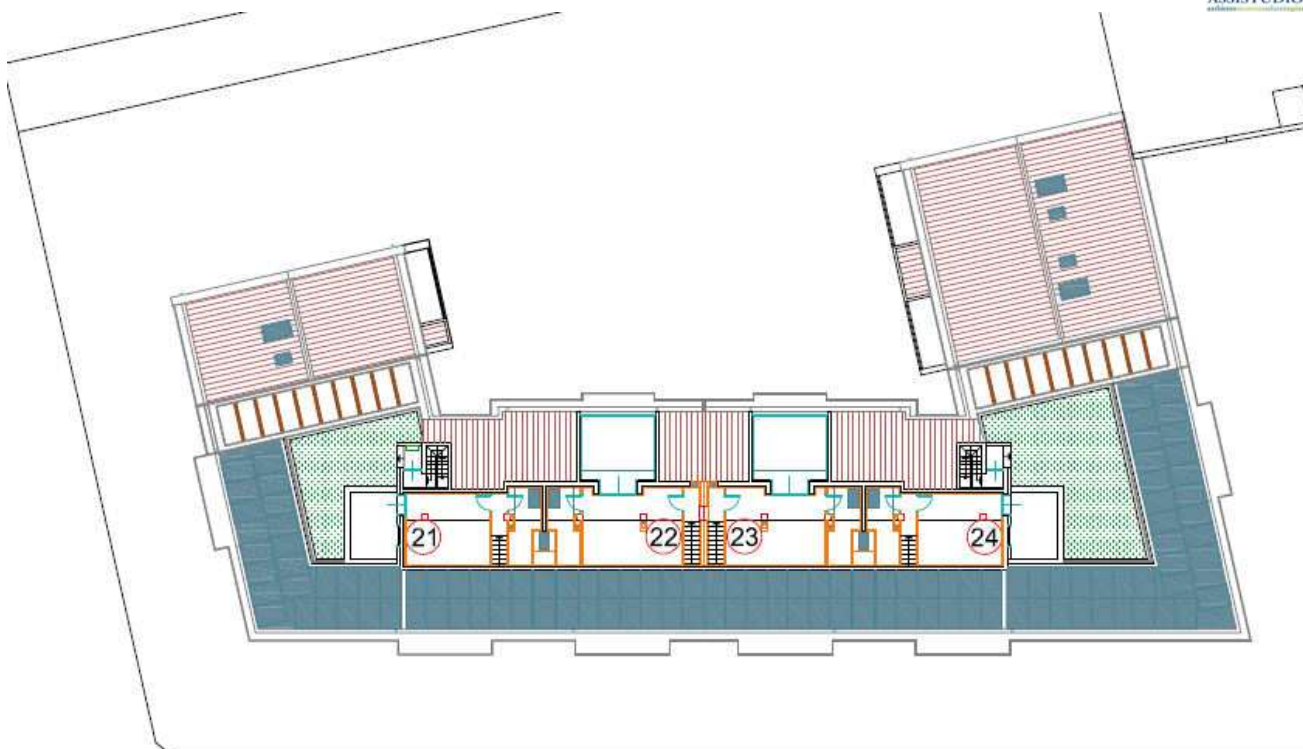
D STATO DI PROGETTO –PIANO TERZO, SOTTOTETTO
